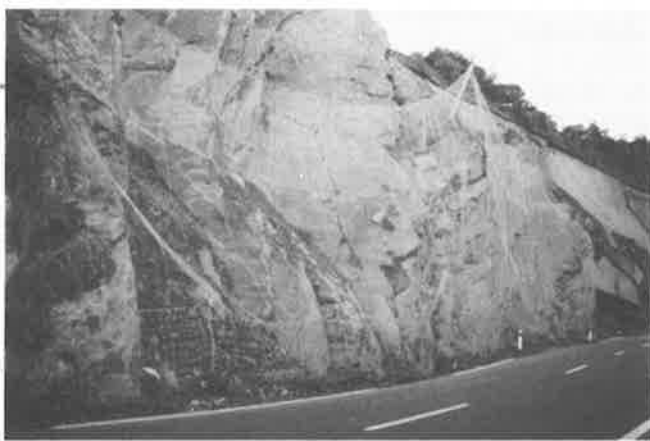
Malla de alambre de triple torsión colgada con la zona inferior reforzada con red de cables
